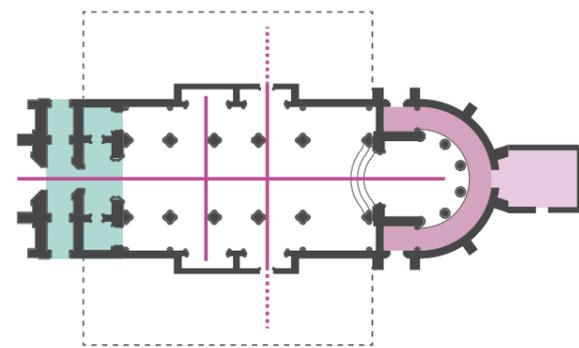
Configuración planta iglesia . Fuente: elaboración propia
